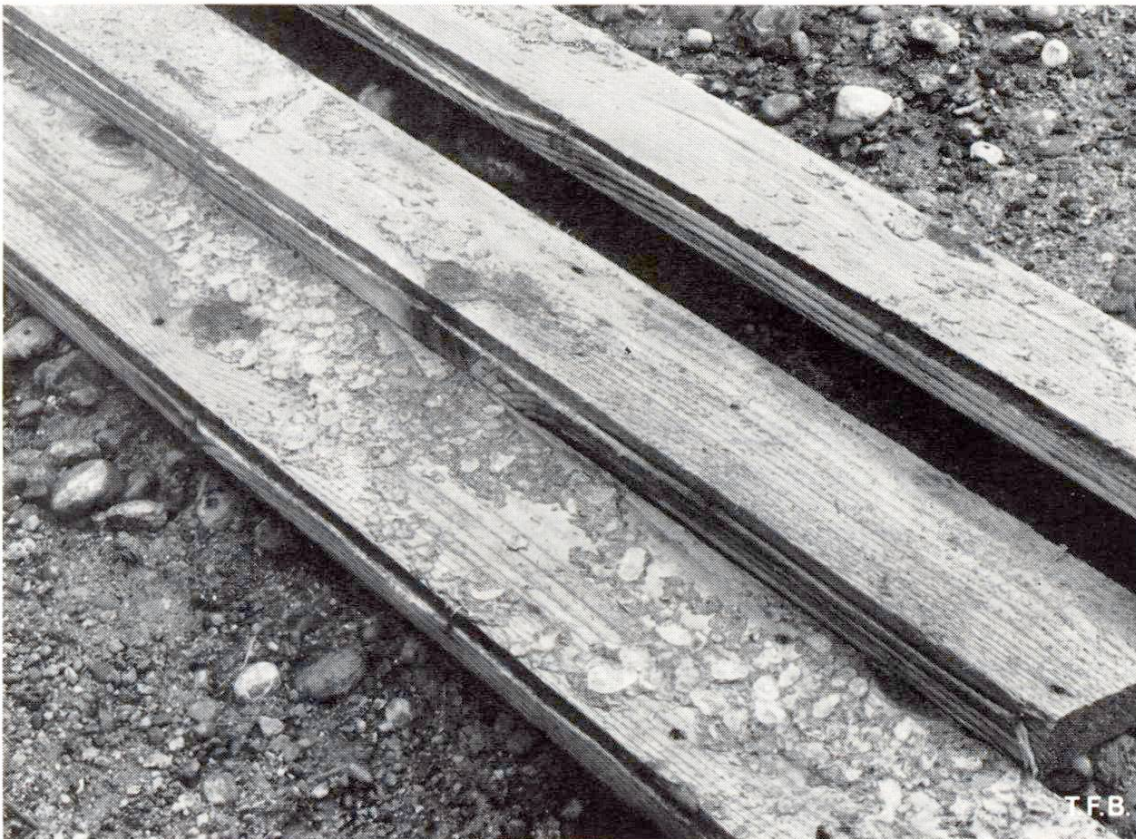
Beim Ausschalen abgerissene Zementhaut an der Untersicht einer starken Betondecke.
